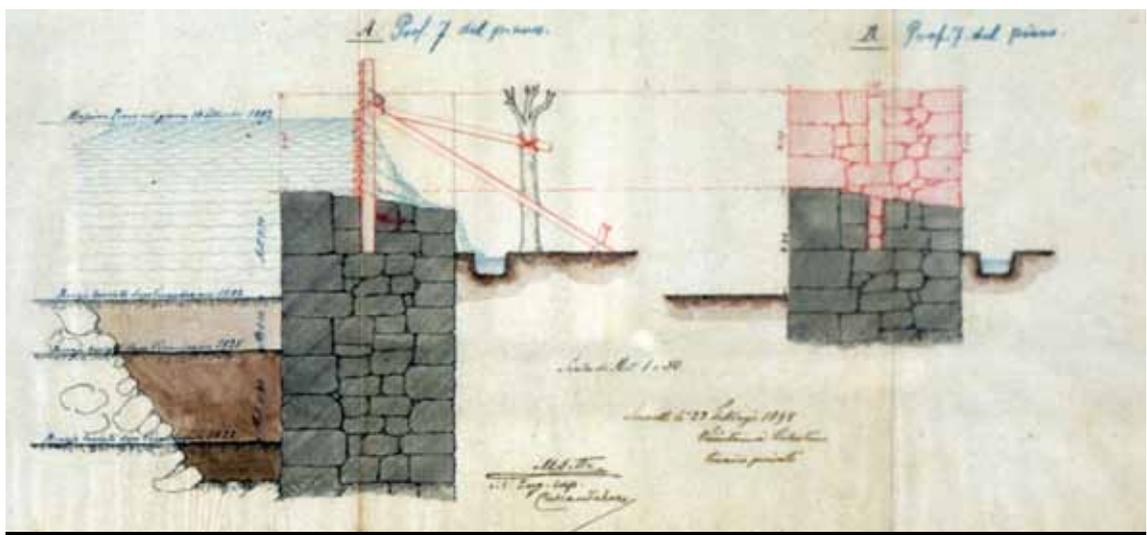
FOTO Progetto per il rialzo dell’arginatura sul torrente Maso, dopo l’alluvione del 1882.
